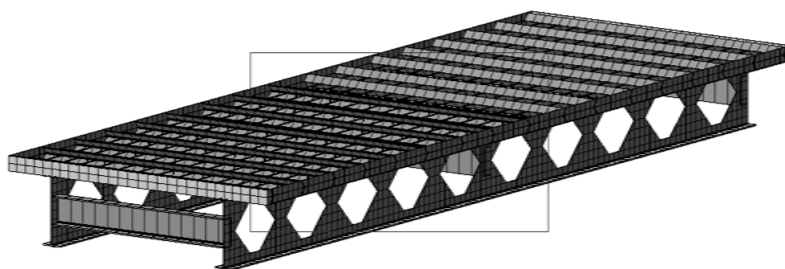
Конечно-элементная модель пролетного строения со сквозными балками без железобетонной плиты
